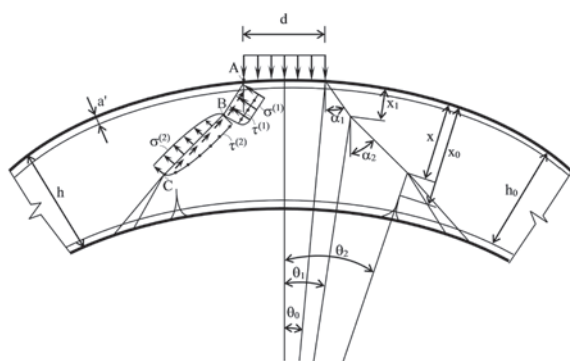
Экспериментально обоснованная локальная схема разрушения железобетонной оболочки
